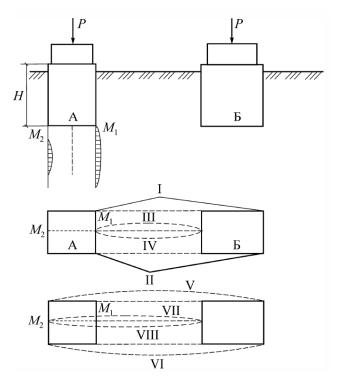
Схема использования метода угловых точек для определения взаимовлияния фундаментов
